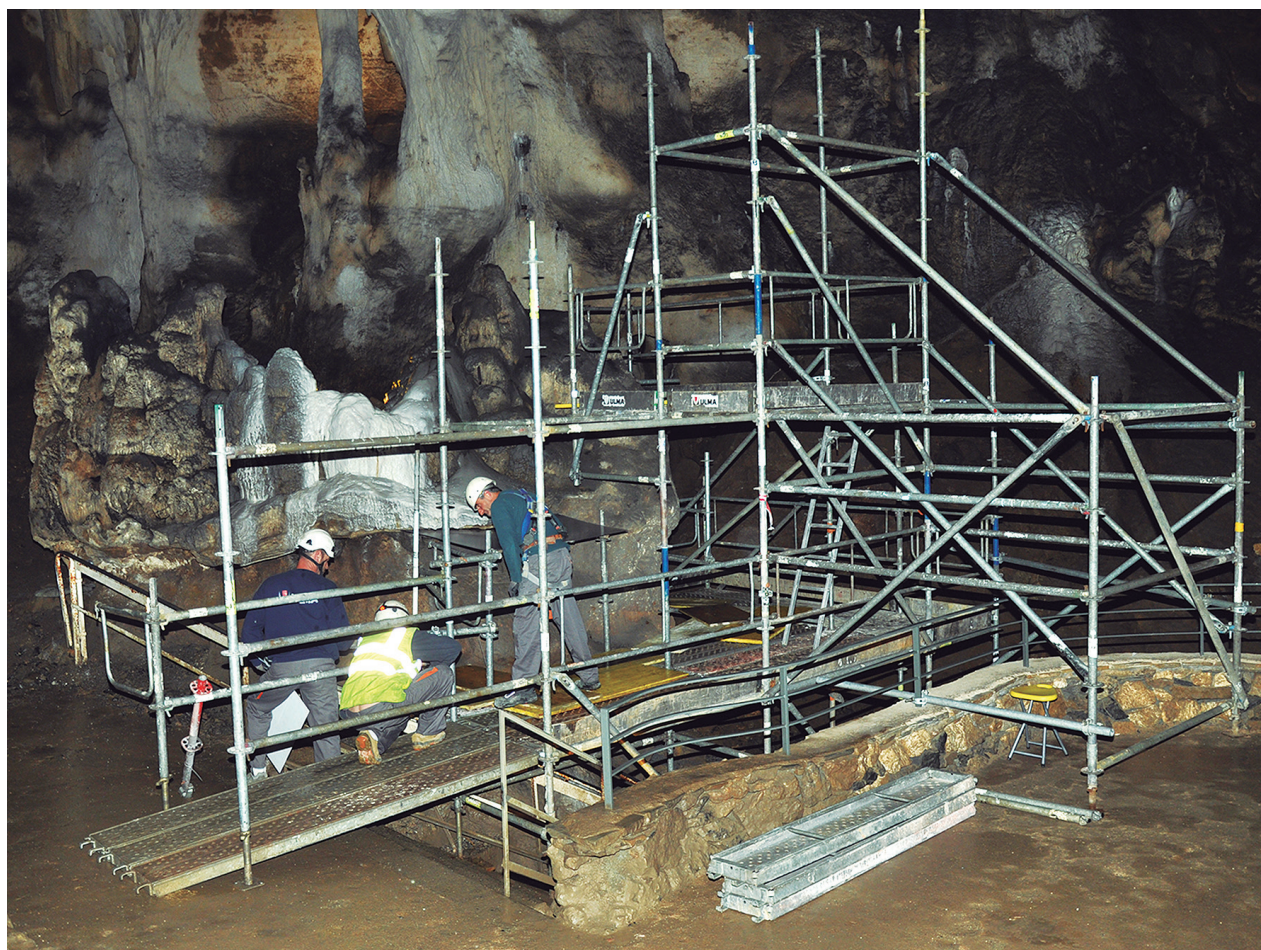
Travaux d'assemblage de l'échafaudage face au Pilier Gravé (A. Labarge).
